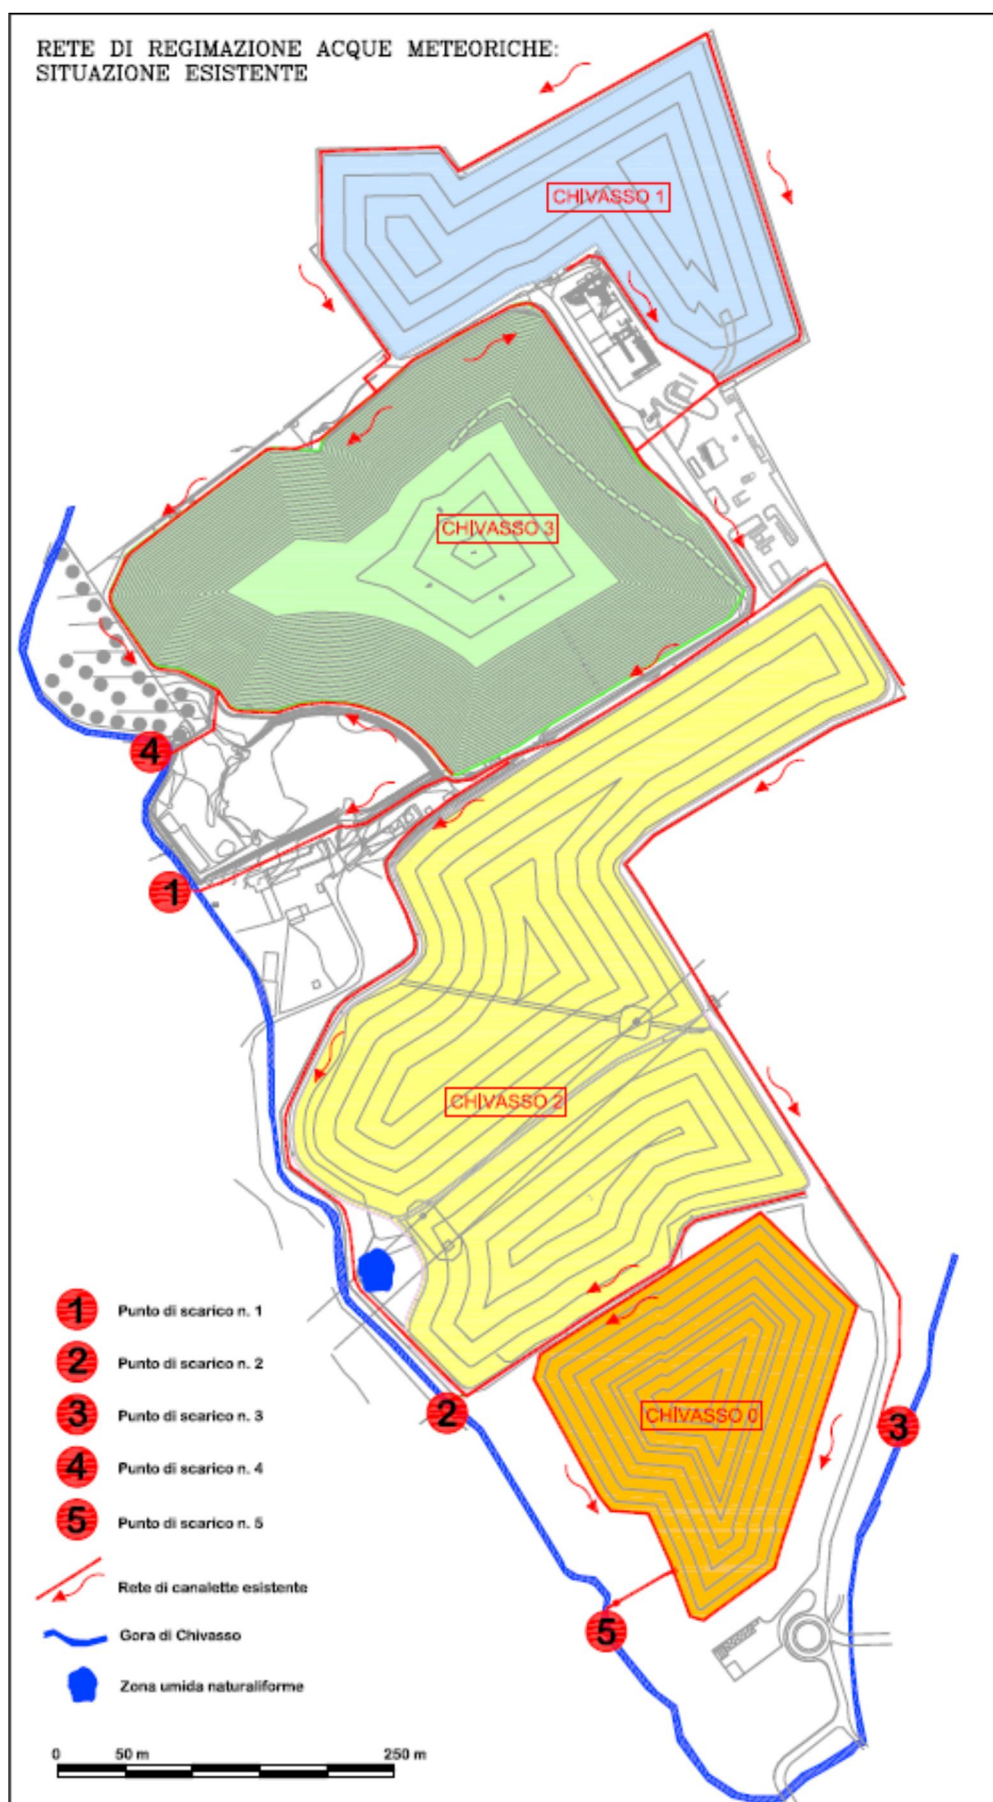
Planimetria della regimazione delle acque meteoriche – stato di fatto
